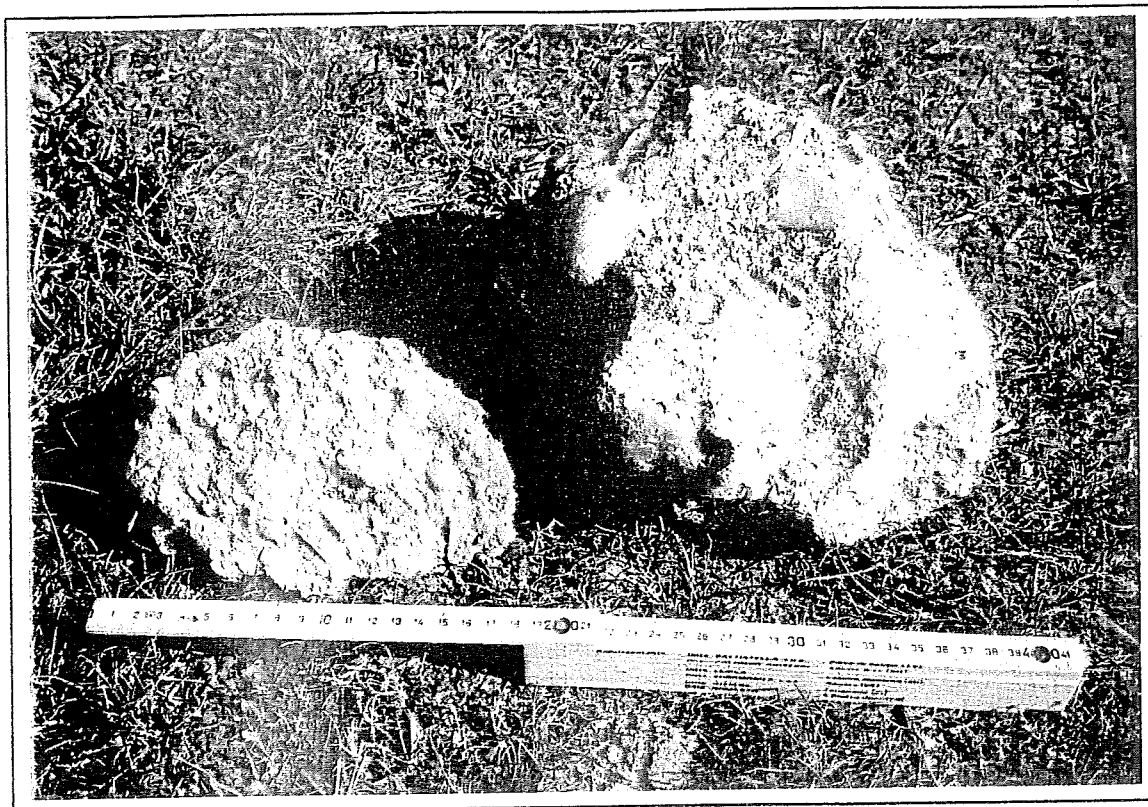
Ciottoli di conglomerato estratti dalla trincea d'ispezione S4
